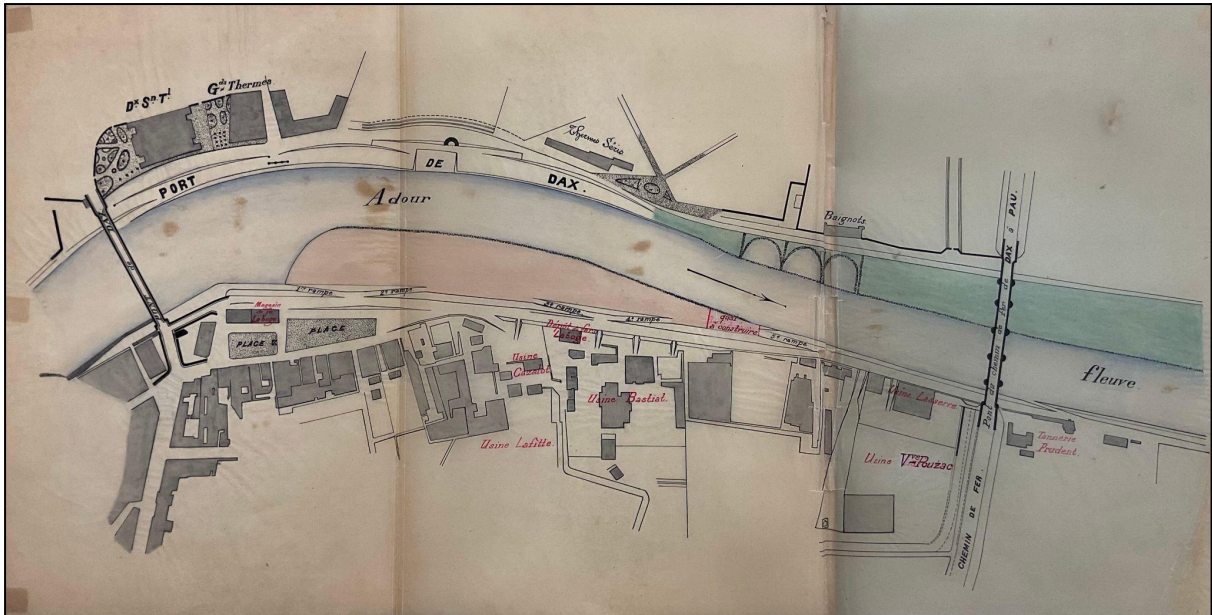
Plan général de la construction d'un quai, 1901 (Source : AD 40, 3 S 141).
